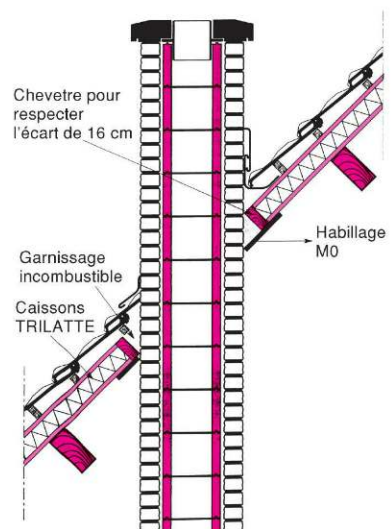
Détail de traversée de toit par un conduit de fumée
